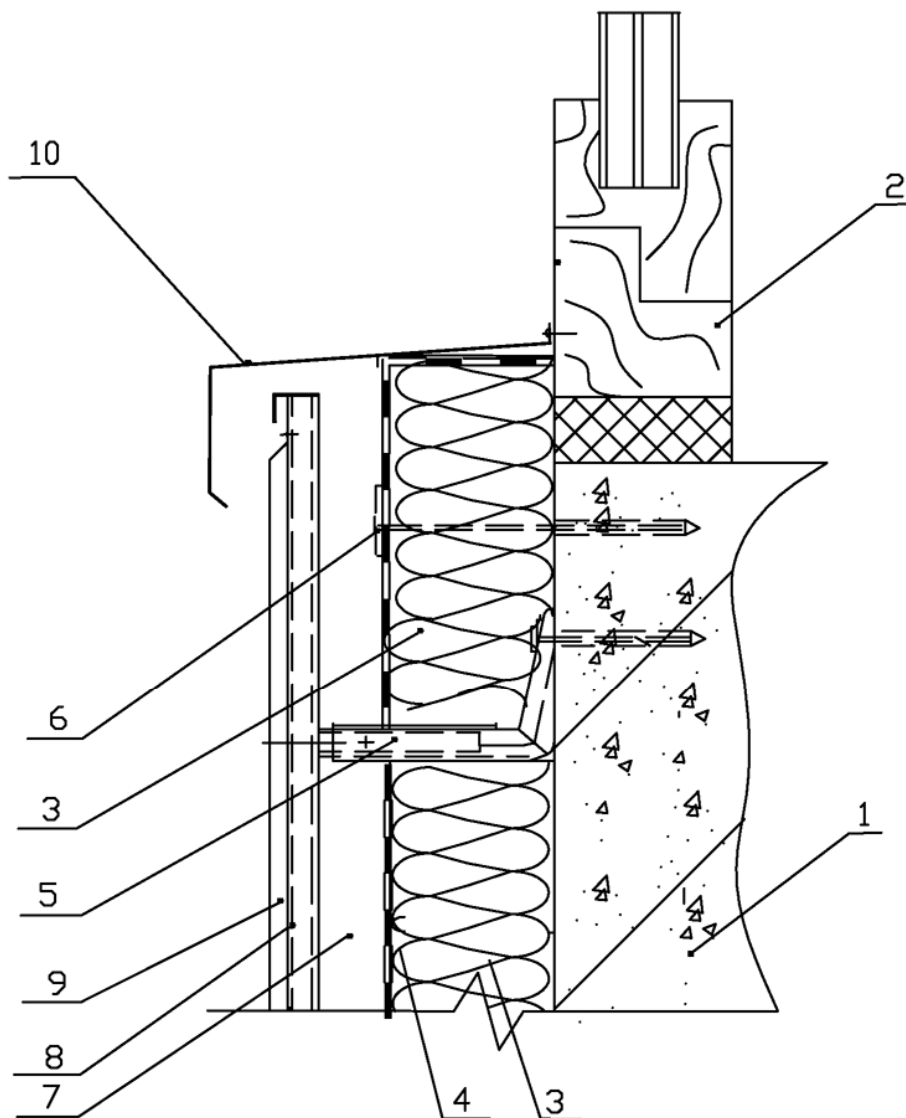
Узел примыкания к парапету стены с теплоизоляцией плитами ИЗОРОК в конструкции вентилируемого фасада. Вариант II.
